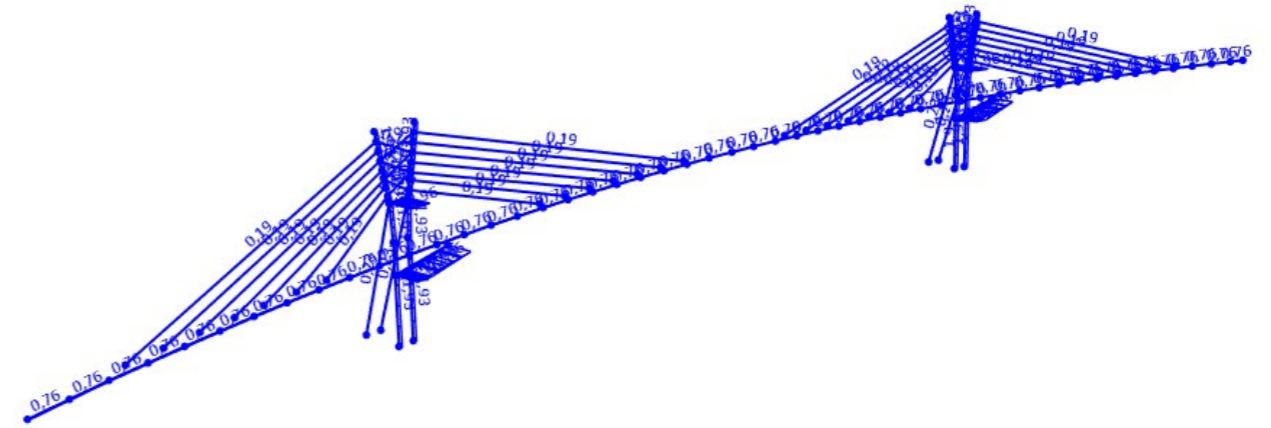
Viento transversal "Y" positivo aplicado sobre el modelo de la estructura. Fuente: Elaboración Propia (SAP2000)
